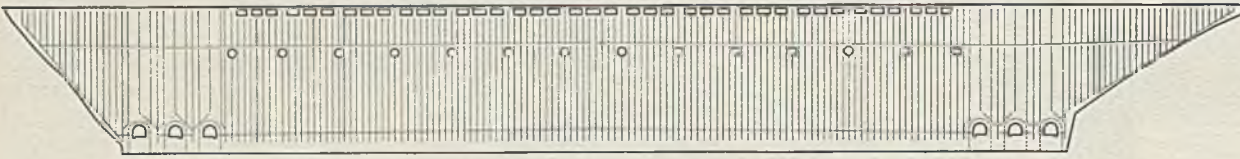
Ansicht der Sperrmauer mit wasserseitigen Mauerdränagen.
